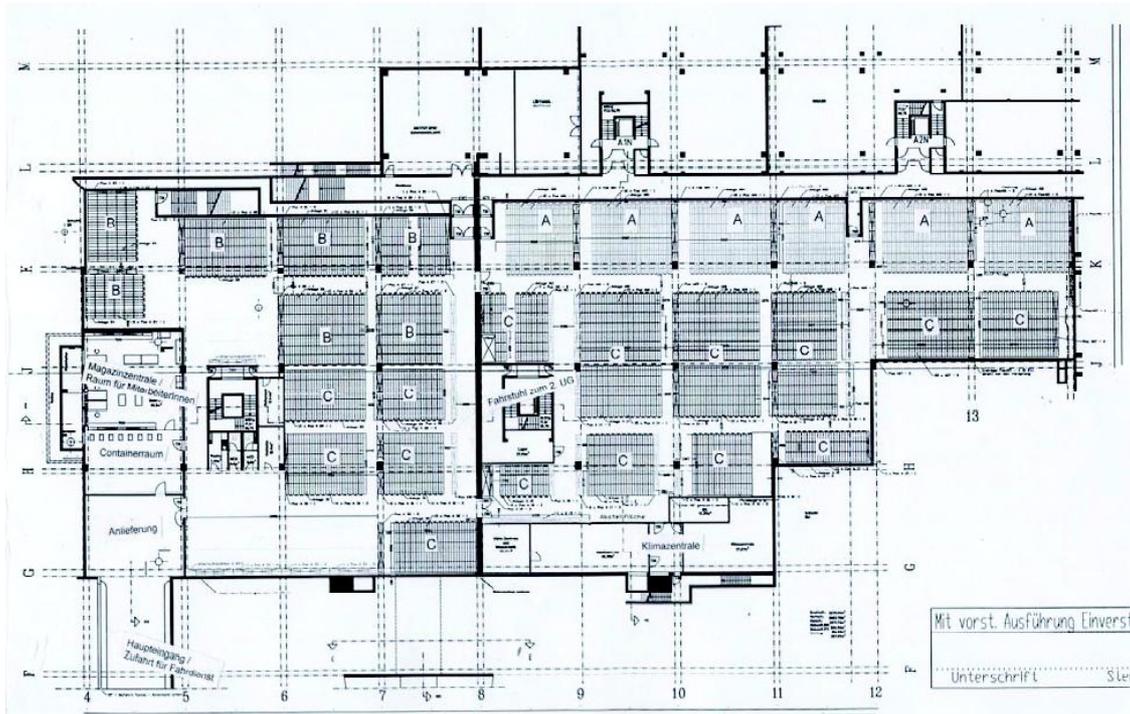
Grundriß für das 1. Untergeschoß des Speichermagazins Bergedorf.²¹⁸ Links unten im Bild befindet sich der Haupteingang des Magazins an der Lohbrügger Kirchstraße. Er dient dem Fahrdienst auch als Zufahrt. An den Bereich Anlieferung grenzt der Containerraum. Dann folgt die Magazinzentrale. Die Technikräume unten rechts im Bild haben einen separaten Zugang von außen. Die Regalblöcke sind zur Aufnahme von Büchern mit unterschiedlichen Formaten ausgestattet (Erläuterung im Text).
